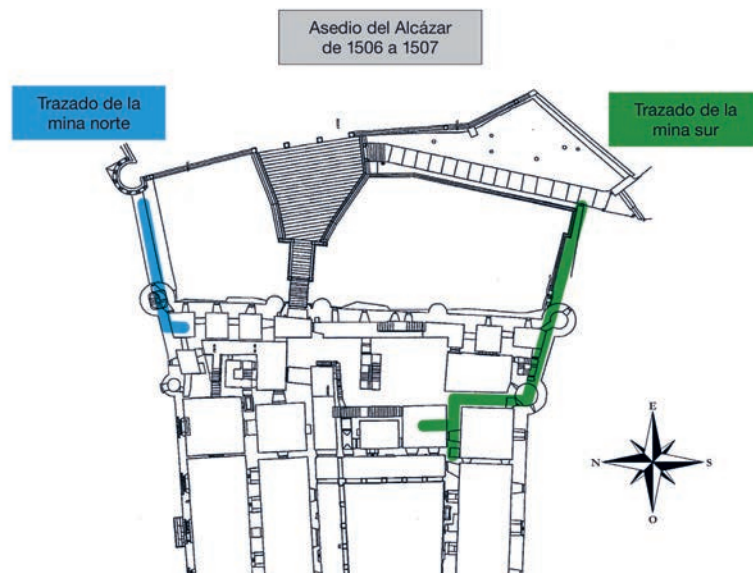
Trazado de las minas excavadas durante el asedio de 1506-07. Esquema: Óscar Silvestre sobre plano de la ETSAM.
